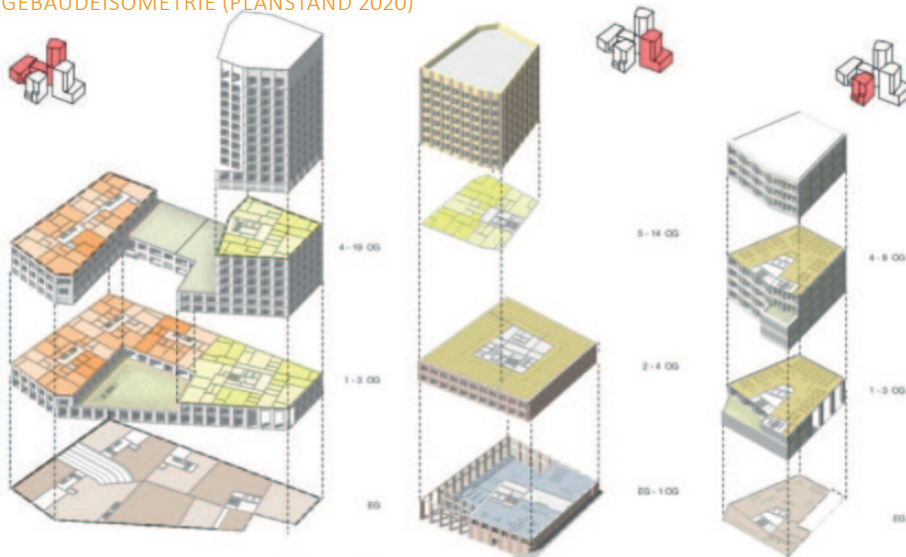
Gebäudeisometrie zur Projektorientierung (Müller-Reimann Architekten, Stand: 2020)
